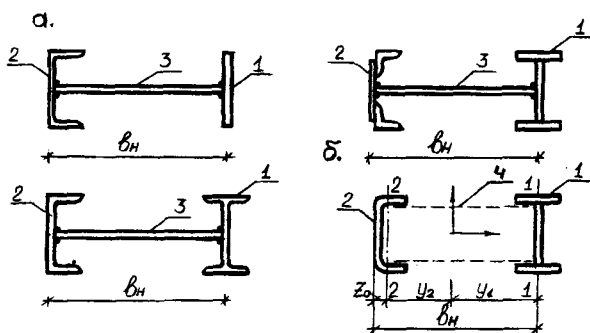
Варианты сечений колонн со сплошной стенкой (а) и сквозных (б): 1 — крановая ветвь; 2 — наружная ветвь; 3 — стенка; 4 — решетка
